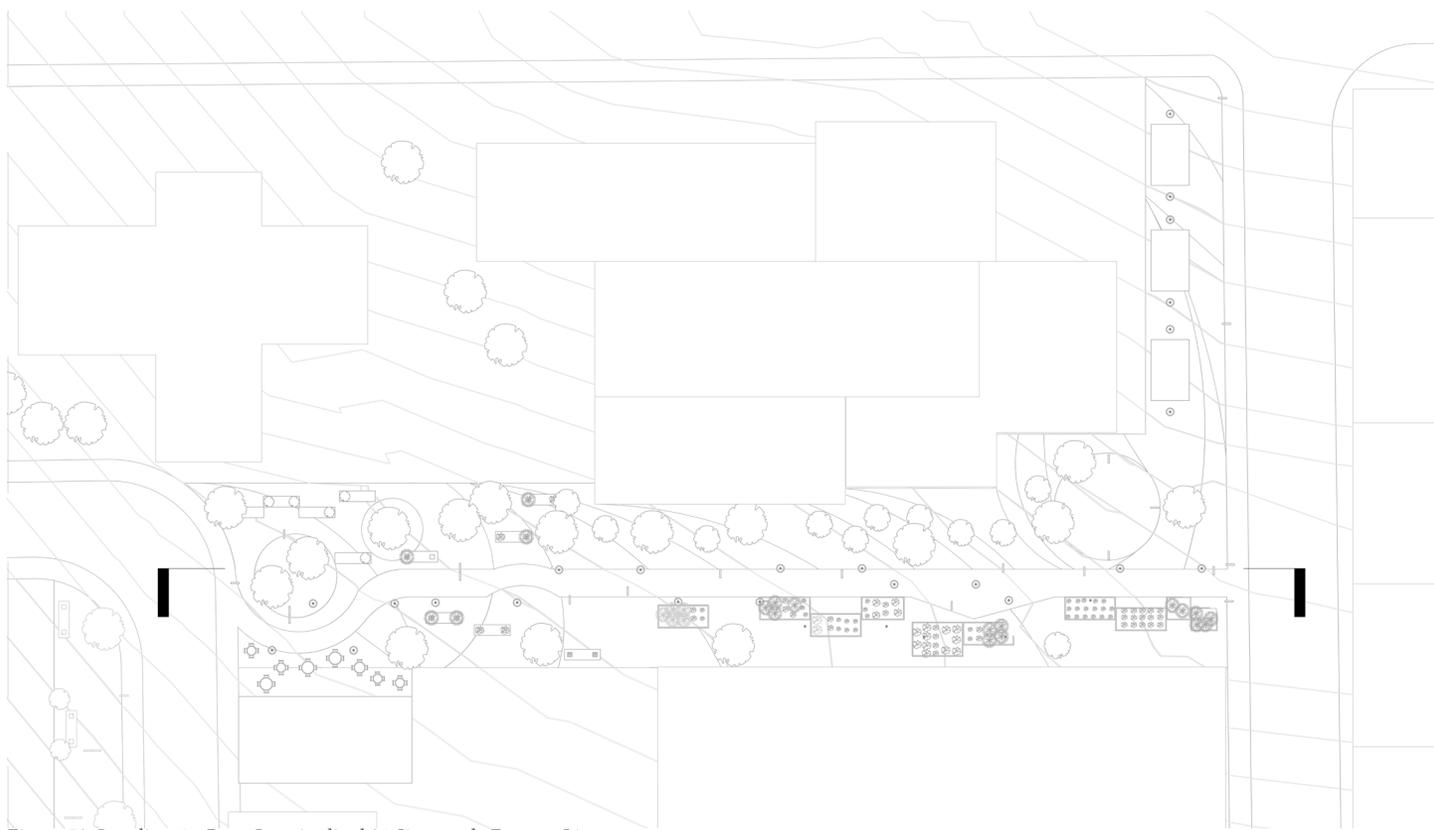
Localização Corte Longitudinal 01 Sistema de Espaços Livres
